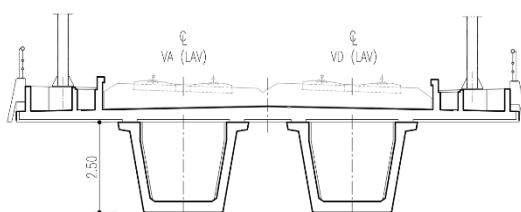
Ponte sobre a ribeira Sra. de Lamas - Secção transversal do tabuleiro em dupla viga-caixão
